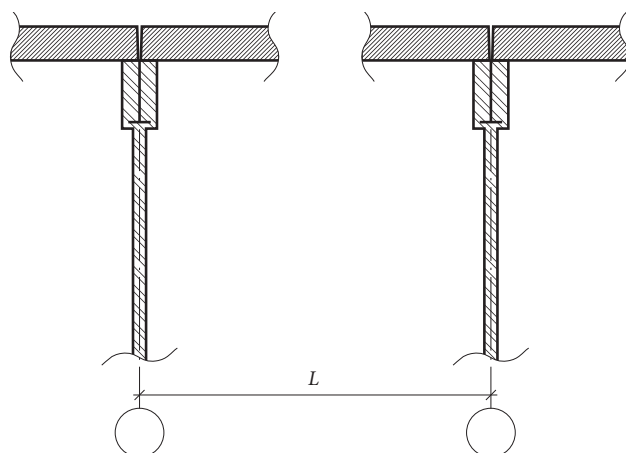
Расположение балки перекрытия вдоль стены помещения
